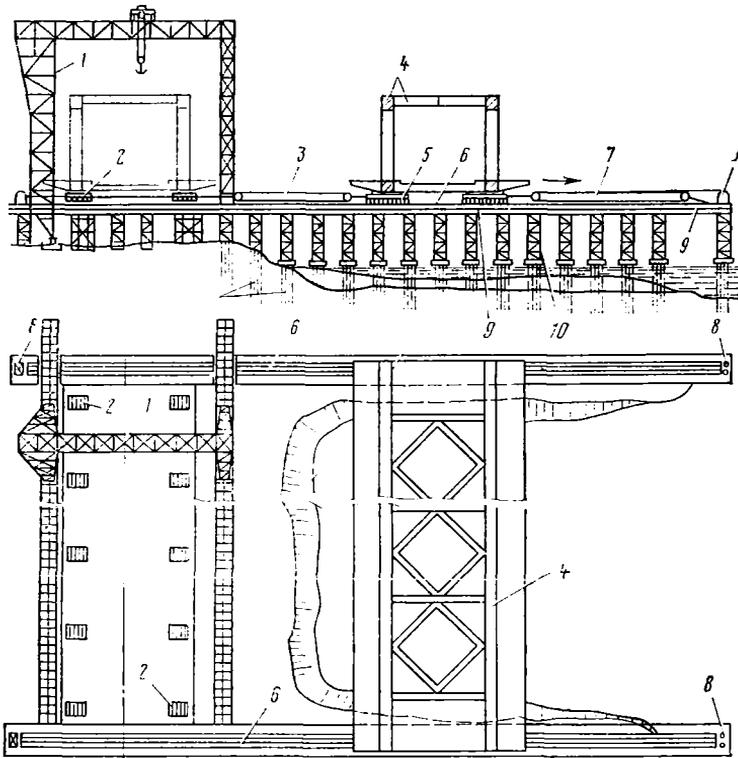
Схема береговых устройств для сборки и поперечной перекатки пролетных строений по пирсам:
